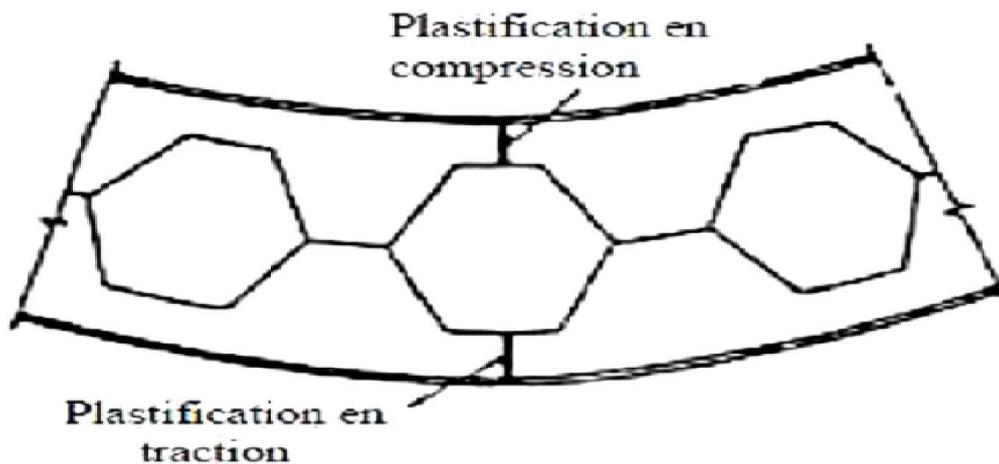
Ruine par flexion transversale de la section perforée [2].
